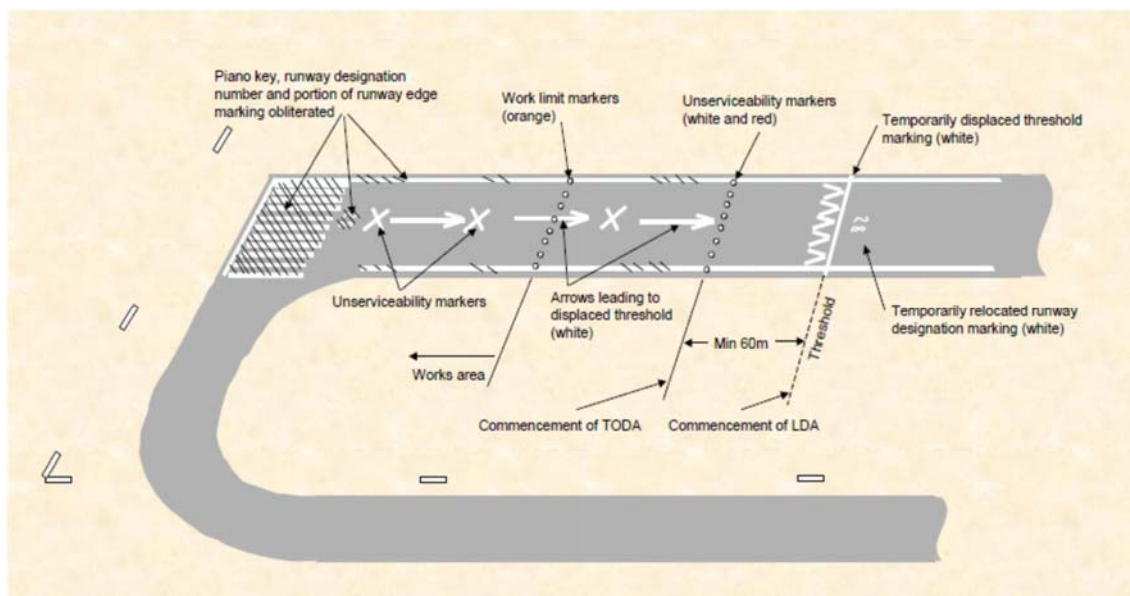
Vijëzimet për një prag të zhvendosur përkohësisht për shkak të punimeve në pistë për një periudhë më të madhe se 30 ditë
